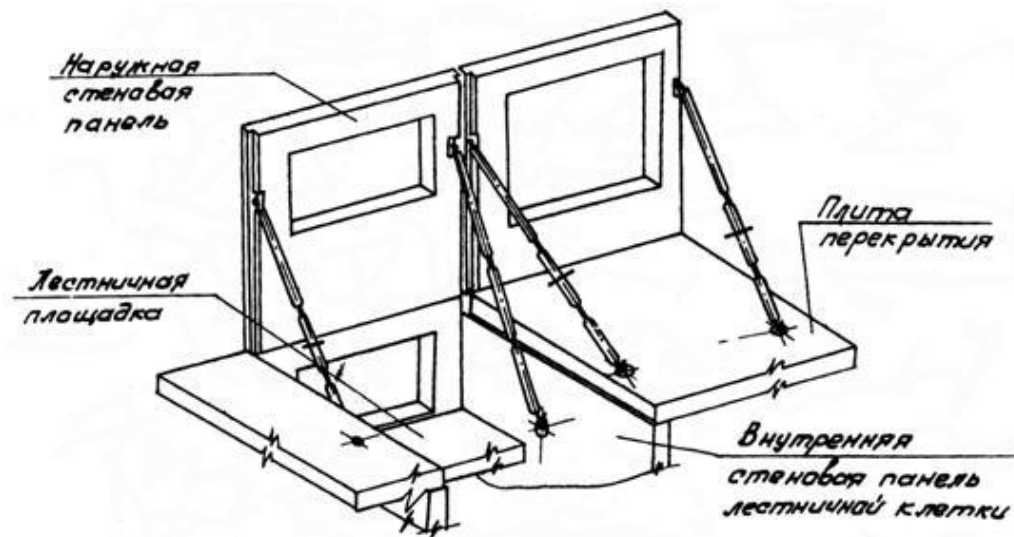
Временное крепление наружной стеновой панели, ограждающей лестничную клетку
